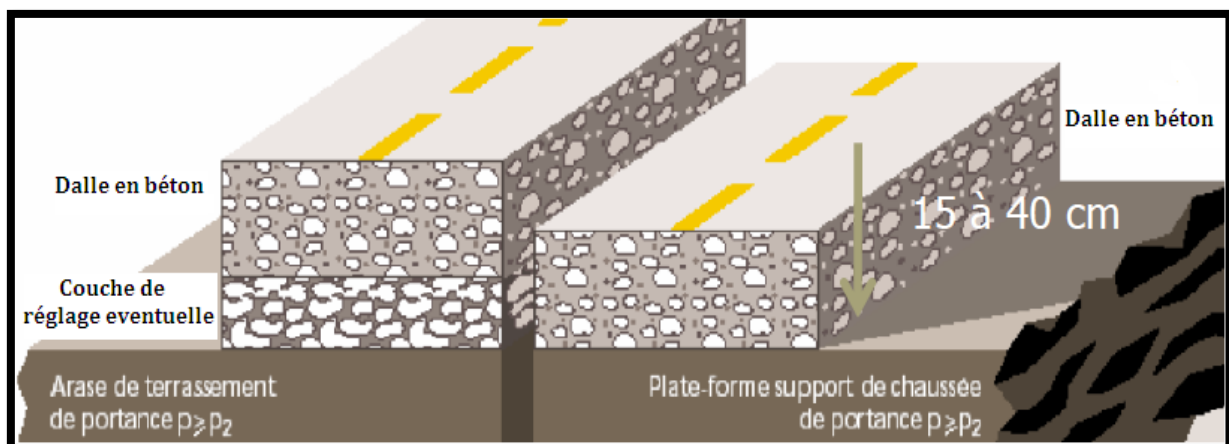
Structure type d'une chaussée rigide. [20]
